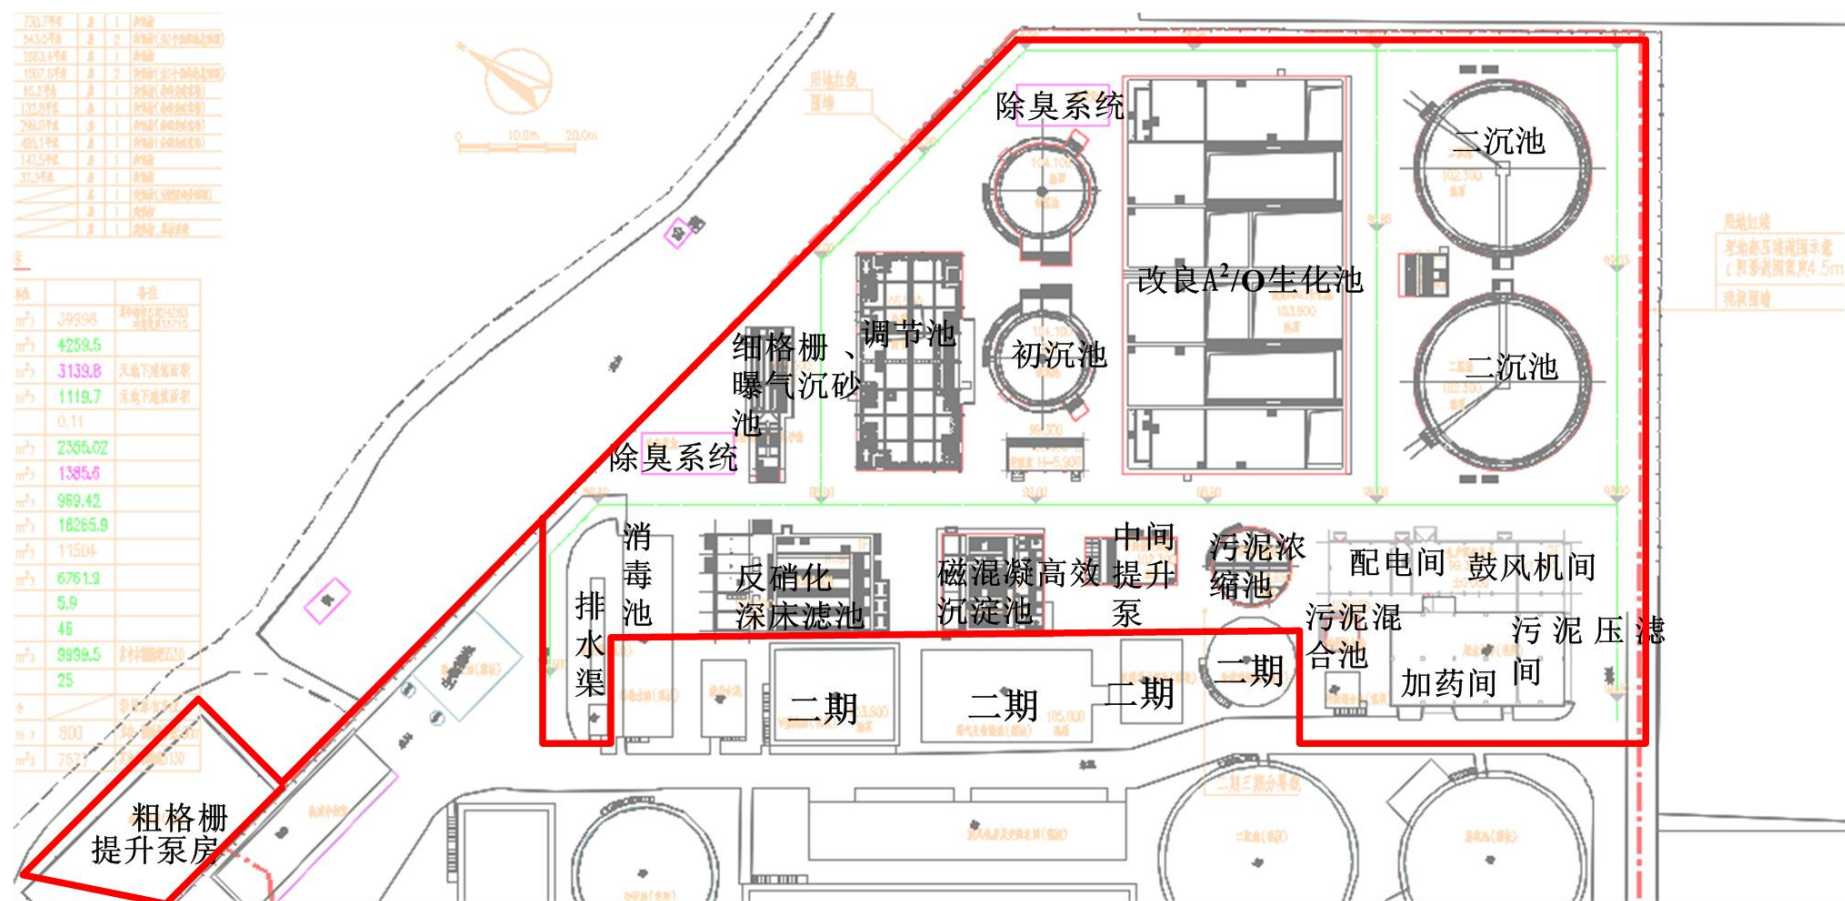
实际厂区平面布置（本次验收范围红线内）
